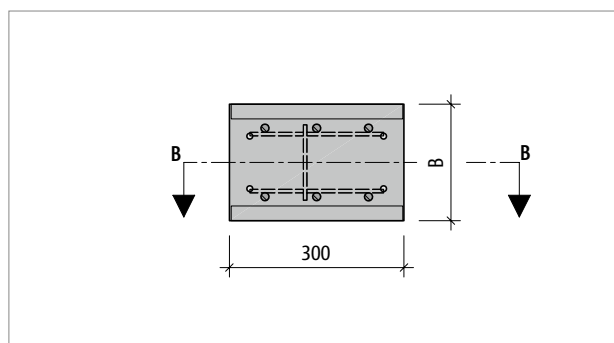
Schöck Sconnex® type W-T2 : projection horizontale du produit
